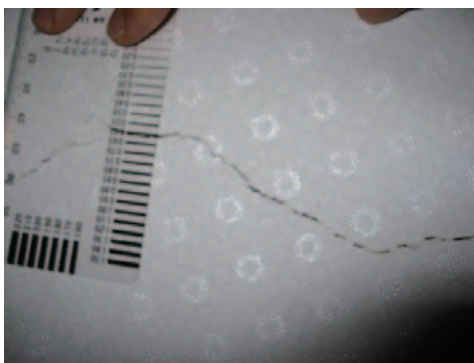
4階の鉄筋コンクリート造内壁に見られた亀裂
